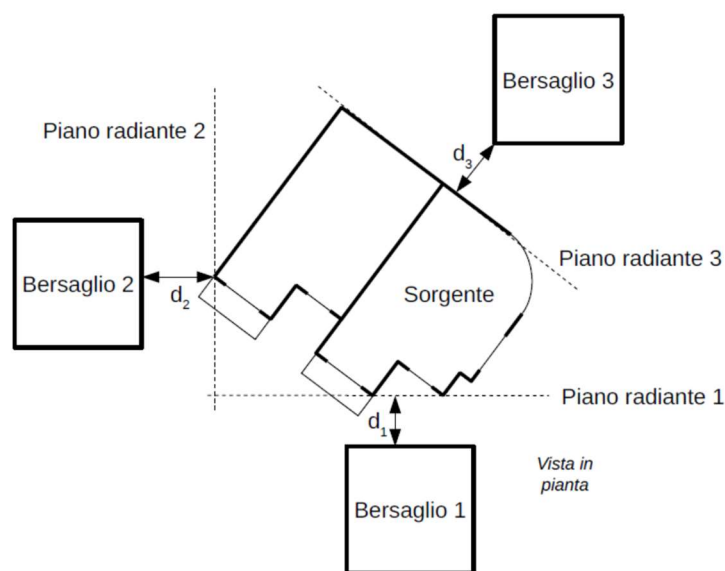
Determinazione del piano radiante, vista in pianta delle costruzioni
